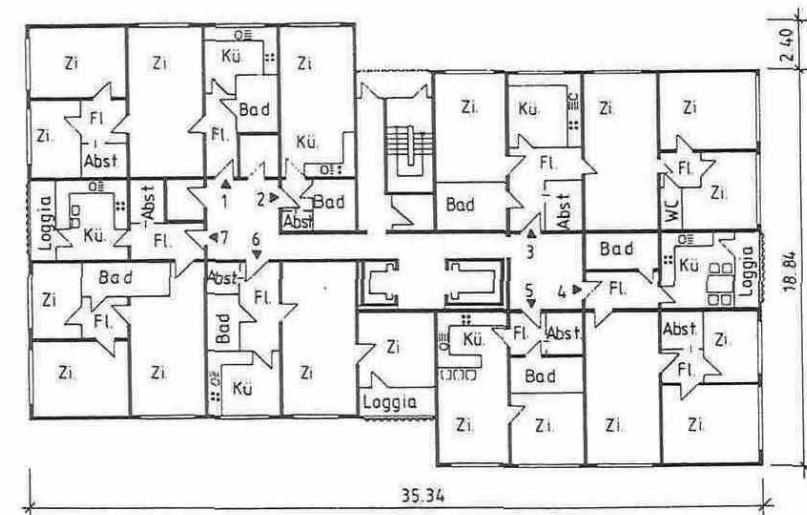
Lösungsvorschlag für umfangreiche Grundrißveränderungen innerhalb eines Normalgeschosses am Beispiel eines Normalgeschoßgrundrisses, WHH GT 18
